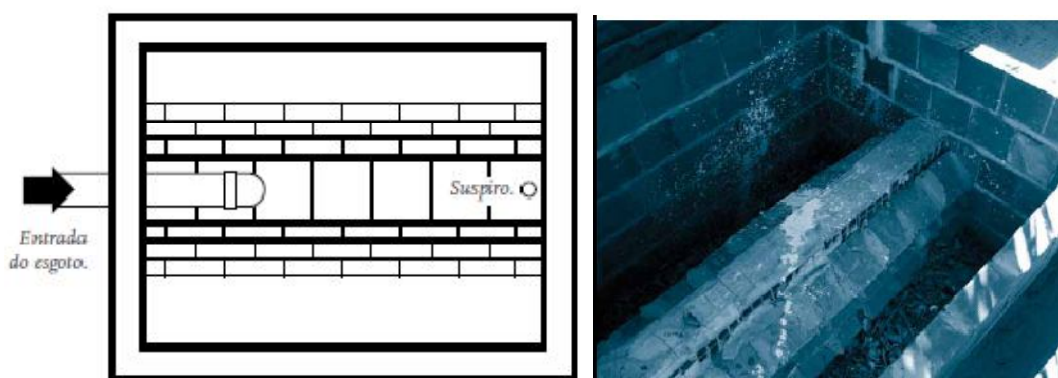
Tanques de biorremediação - fase de construção⁹¹
